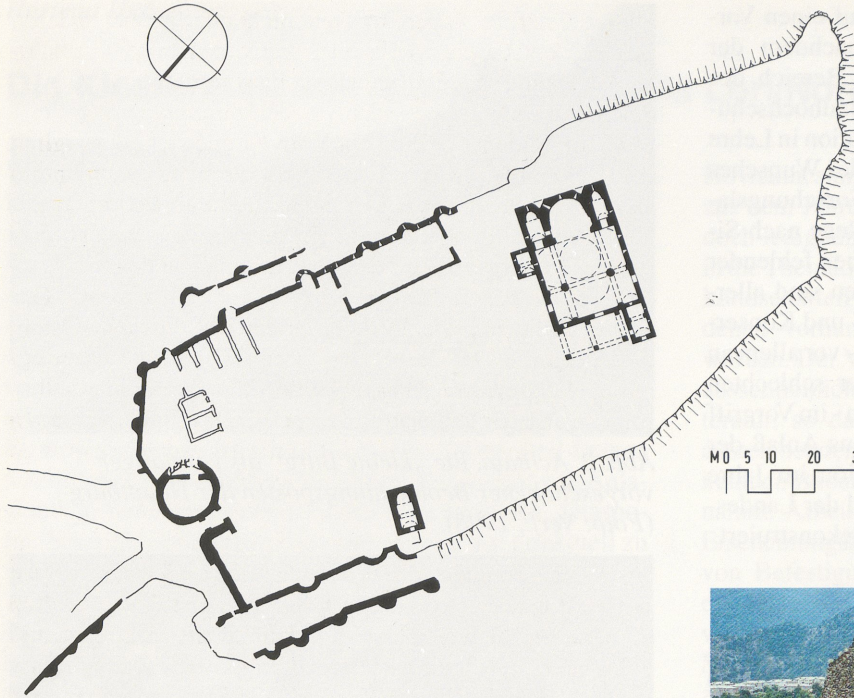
Aghtala, Klosterburg: Lageplan der Anlage (Zeichn.: E. Hafner nach Schachkian, Lori [Fig. 29], mit Korrektur des Kapellengrundrisses).
